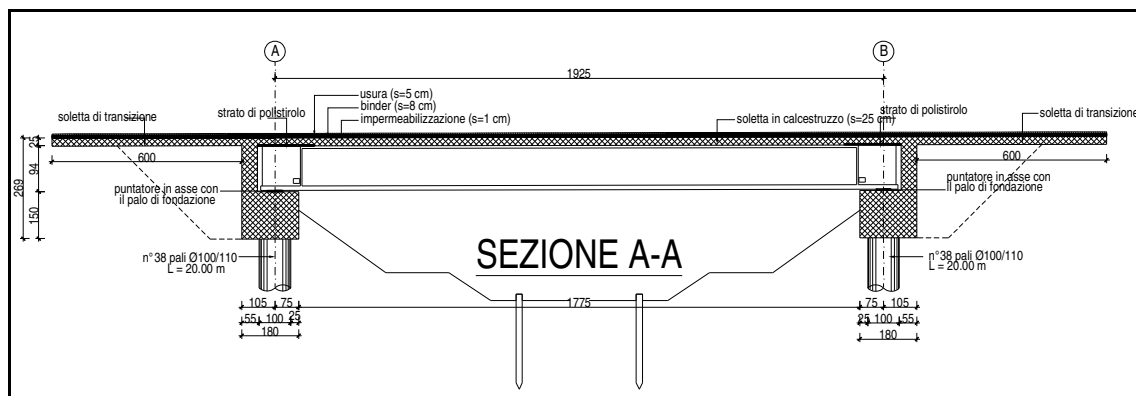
Sezione longitudinale tipica dei ponti oggetto dello studio
